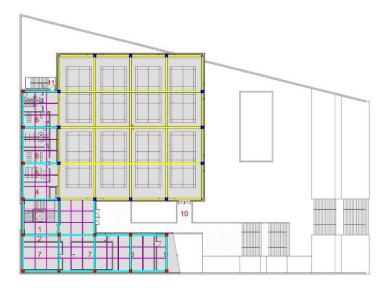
Análisis Estructural Centro San Wayao. Fuente: Elaboración Propia
